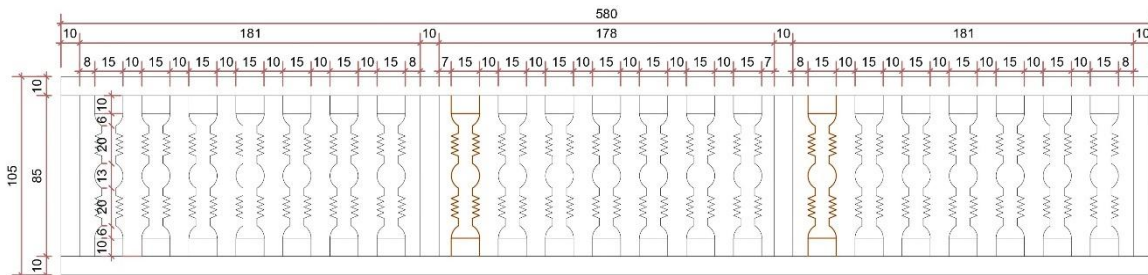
Foto do detalhe do balaústre de madeira a ser executado - Fonte: Projeto Arquitetônico Executivo.
